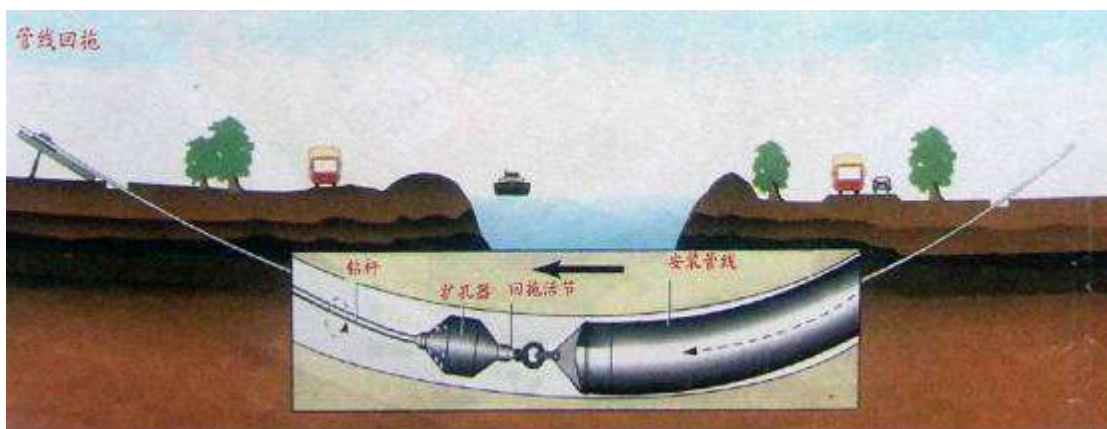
定向钻穿越施工管线回拖过程断面示意图
